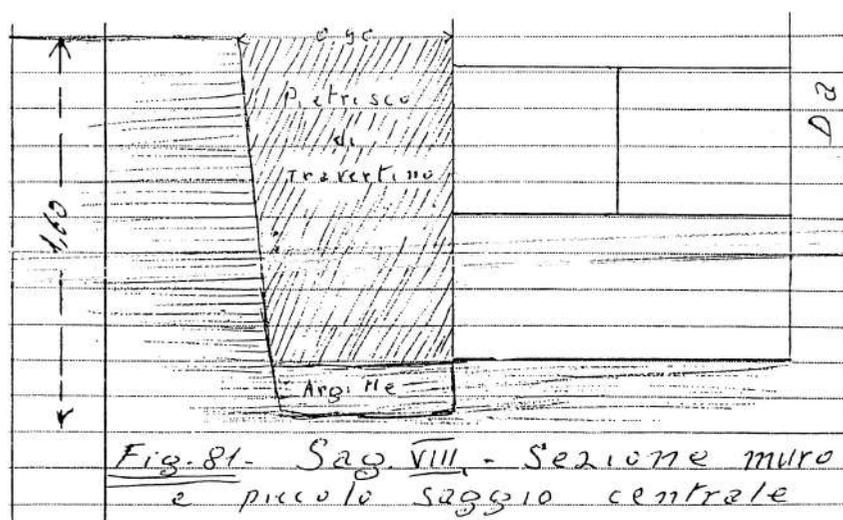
Sag. VIII – sezione muro e piccolo saggio centrale
